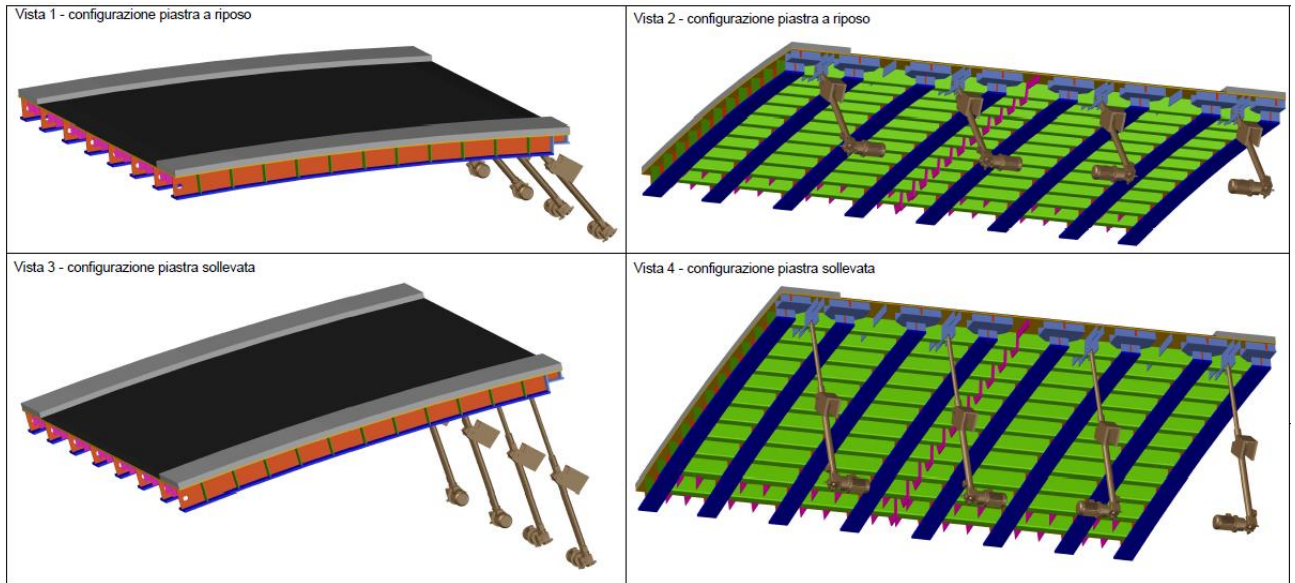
Schemi e sezioni piastra levatoia in acciaio
